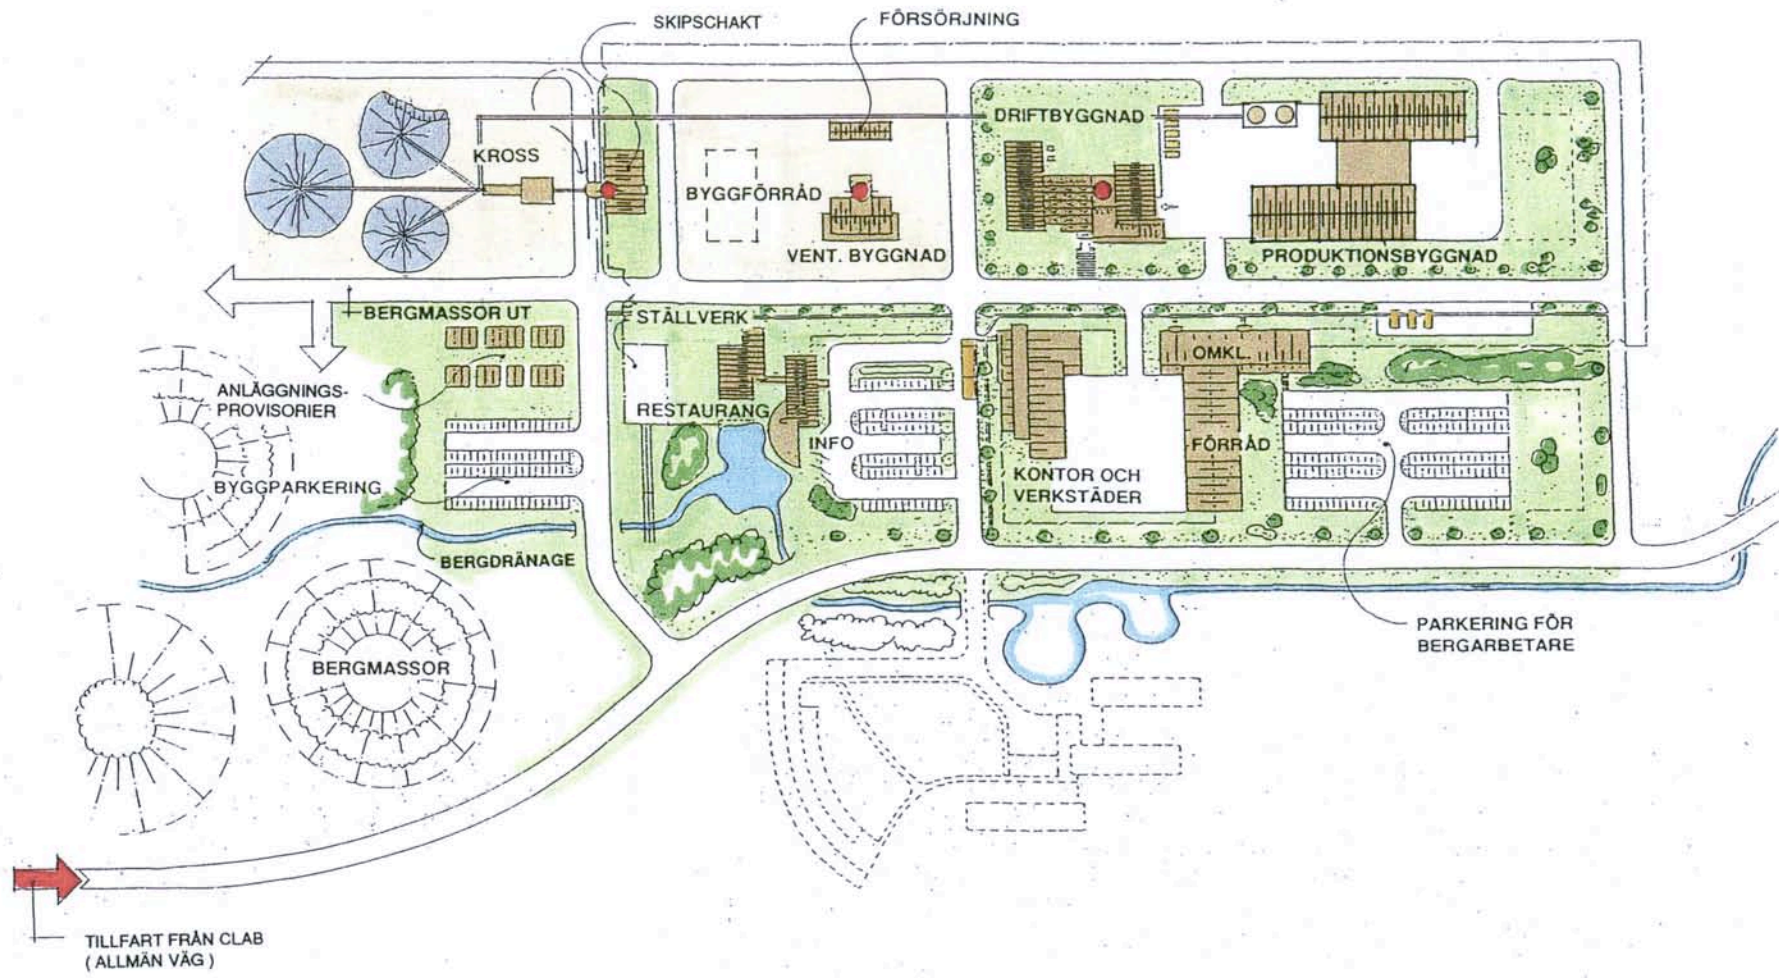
Läge B. Möjlig situationsplan under driftskedet
